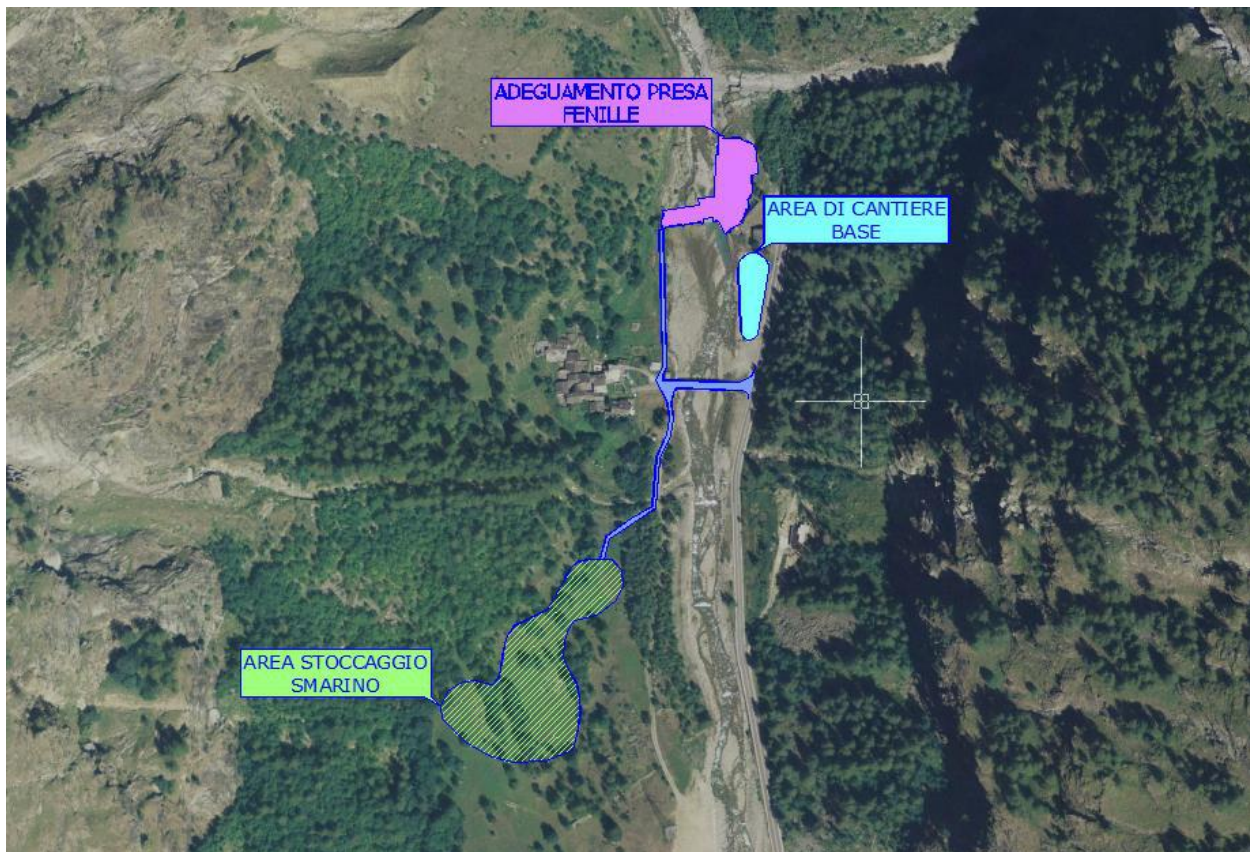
Lotto I cantiere B Adeguamento presa Fenille
